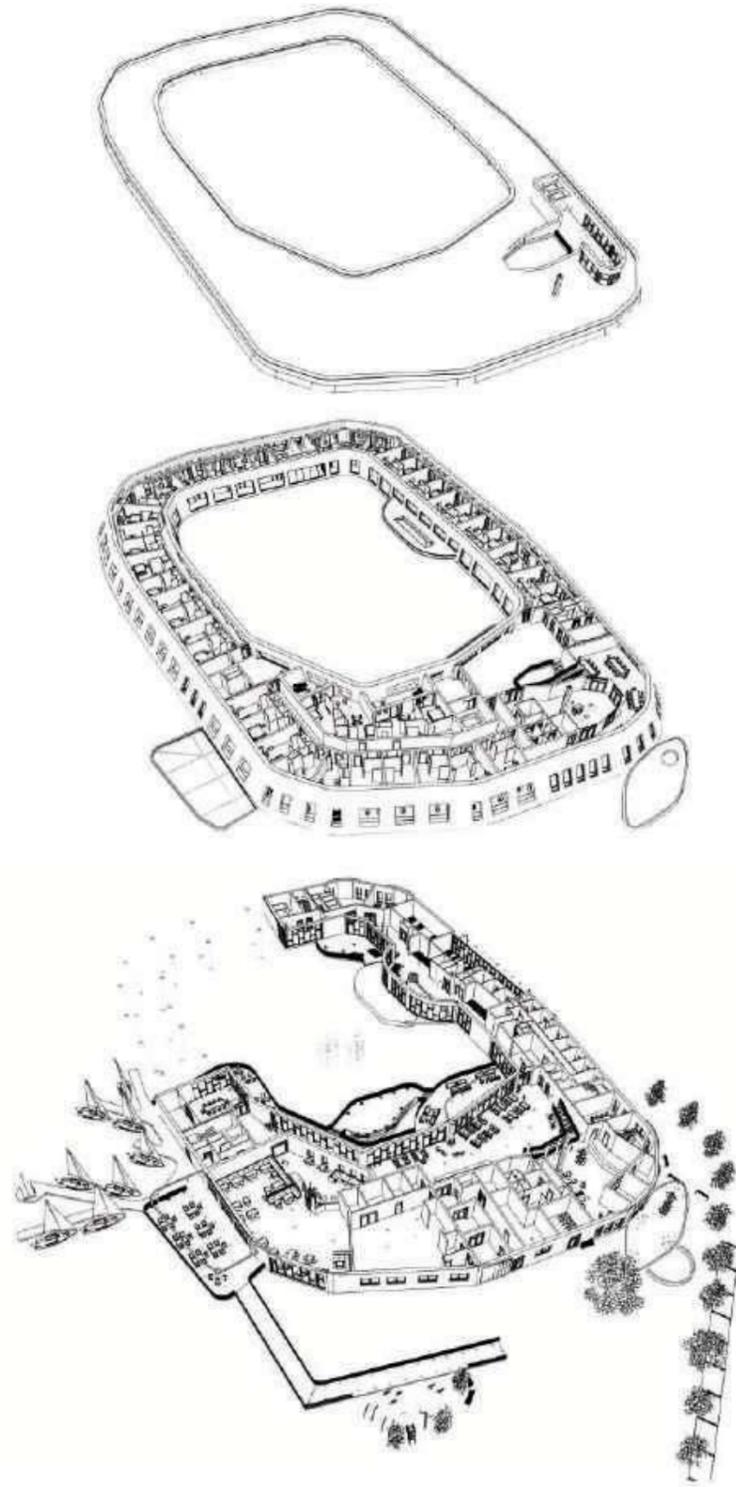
Erdgeschoss, Obergeschoss, Dachgeschoss - Axonometrie
